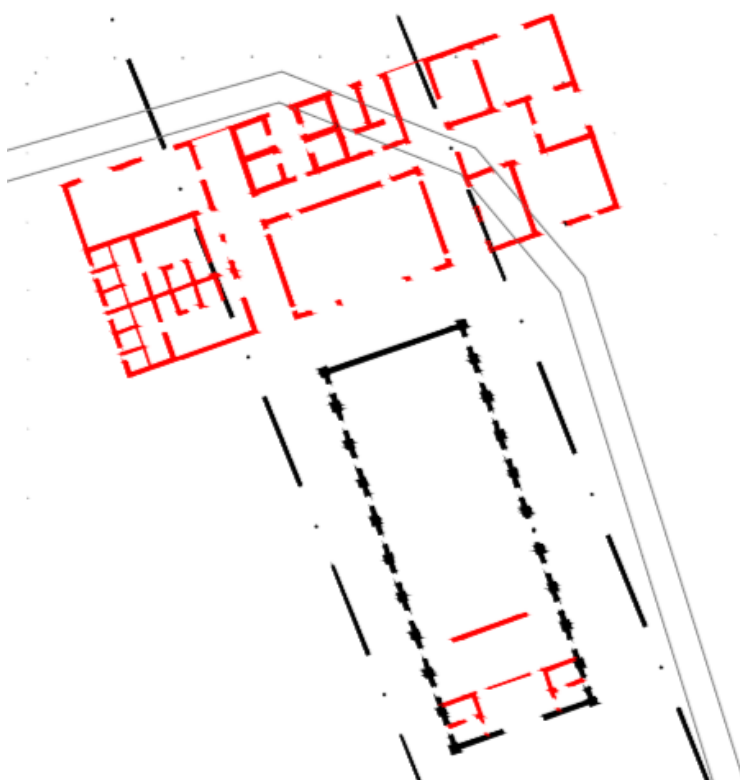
Planta amarelos e encarnados referente ao edifício do Restaurante
